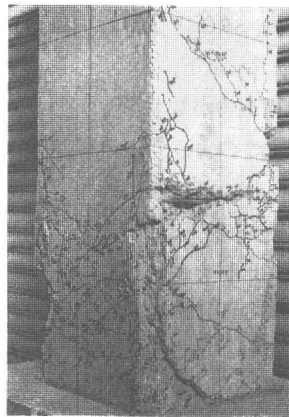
に S300 および S600 試験体の柱脚部の最終破壊状況を示す。各試験体とも部材角 0.0025 rad. まだに曲げひび割れが生じた。その後、S300 試験体を除く各試験体とも部材角 0.005 rad. で曲げせん断ひび割れが生じ、柱頭および柱脚部のコンクリートが圧壊し最大耐力を発揮した。なお、最大耐力時点では、主筋に沿った付着ひび割れも観察された。なお、S1200 試験体は他の試験体に比べ柱頭部の破壊領域が
